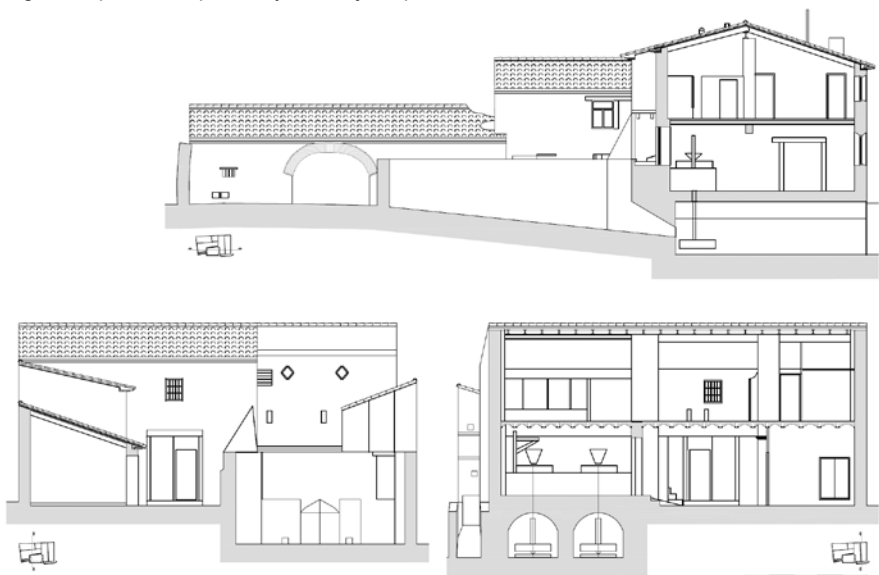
Sección longitudinal y secciones transversales. Fuente: Propia.
